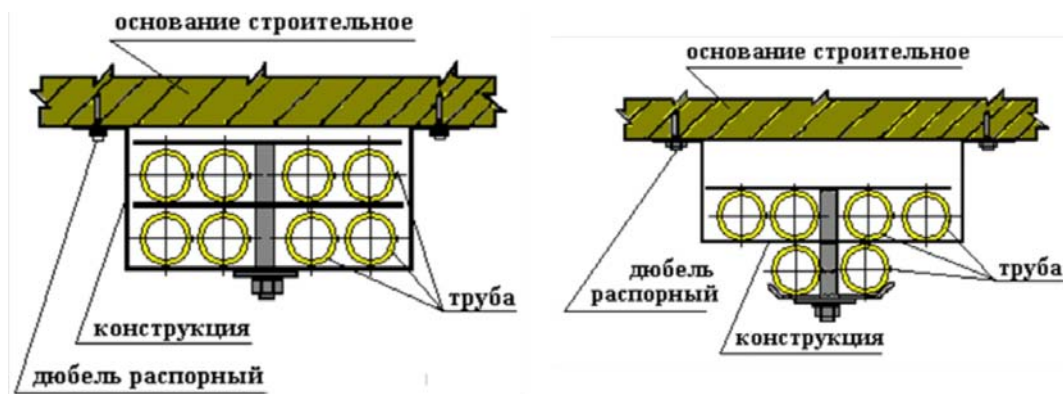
Крепление пластмассовых труб с применением электромонтажной конструкции к строительному основанию с помощью распорного дюбеля
